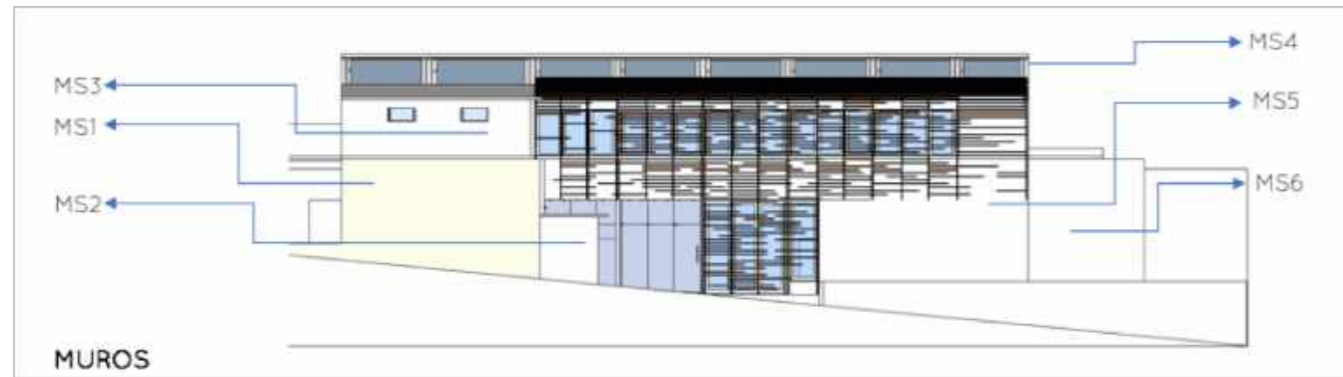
Nomenclatura en muros de fachada sur. Fuente: Elaboración propia
